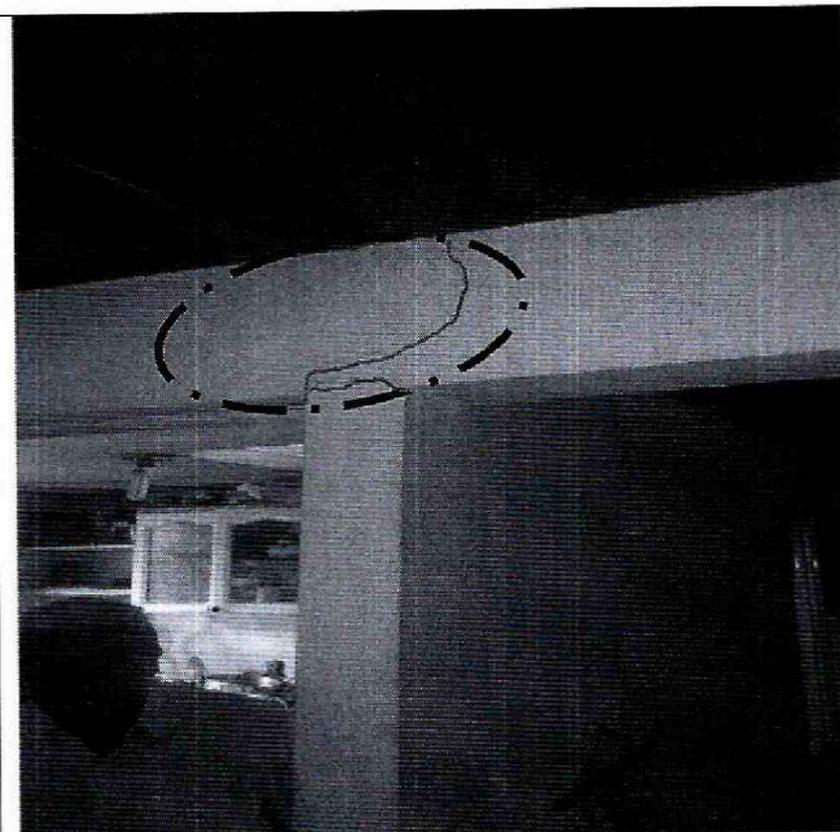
Fisuras identificadas en muros de cerramiento y divisorios en la vivienda de la Calle 137 A No 98 B 21
